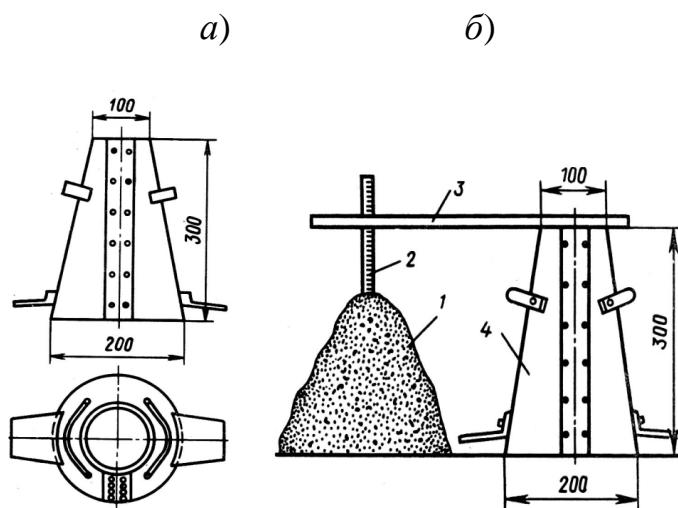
Определение осадки конуса (OK) подвижной бетонной смеси
